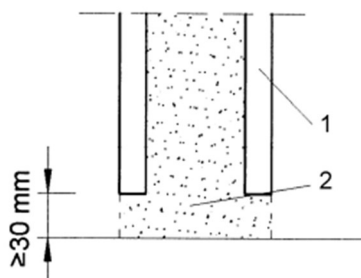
giunto di un muro composito (1, calcestruzzo prefabbricato, 2, calcestruzzo in situ)
